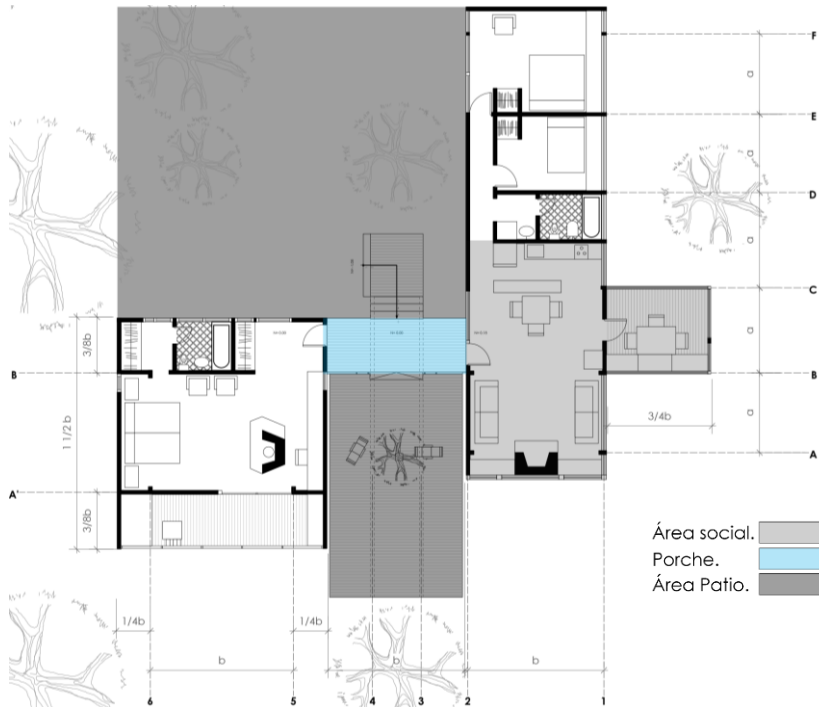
Proporciones del porche en planta baja edificación. Fuente: Autor.
